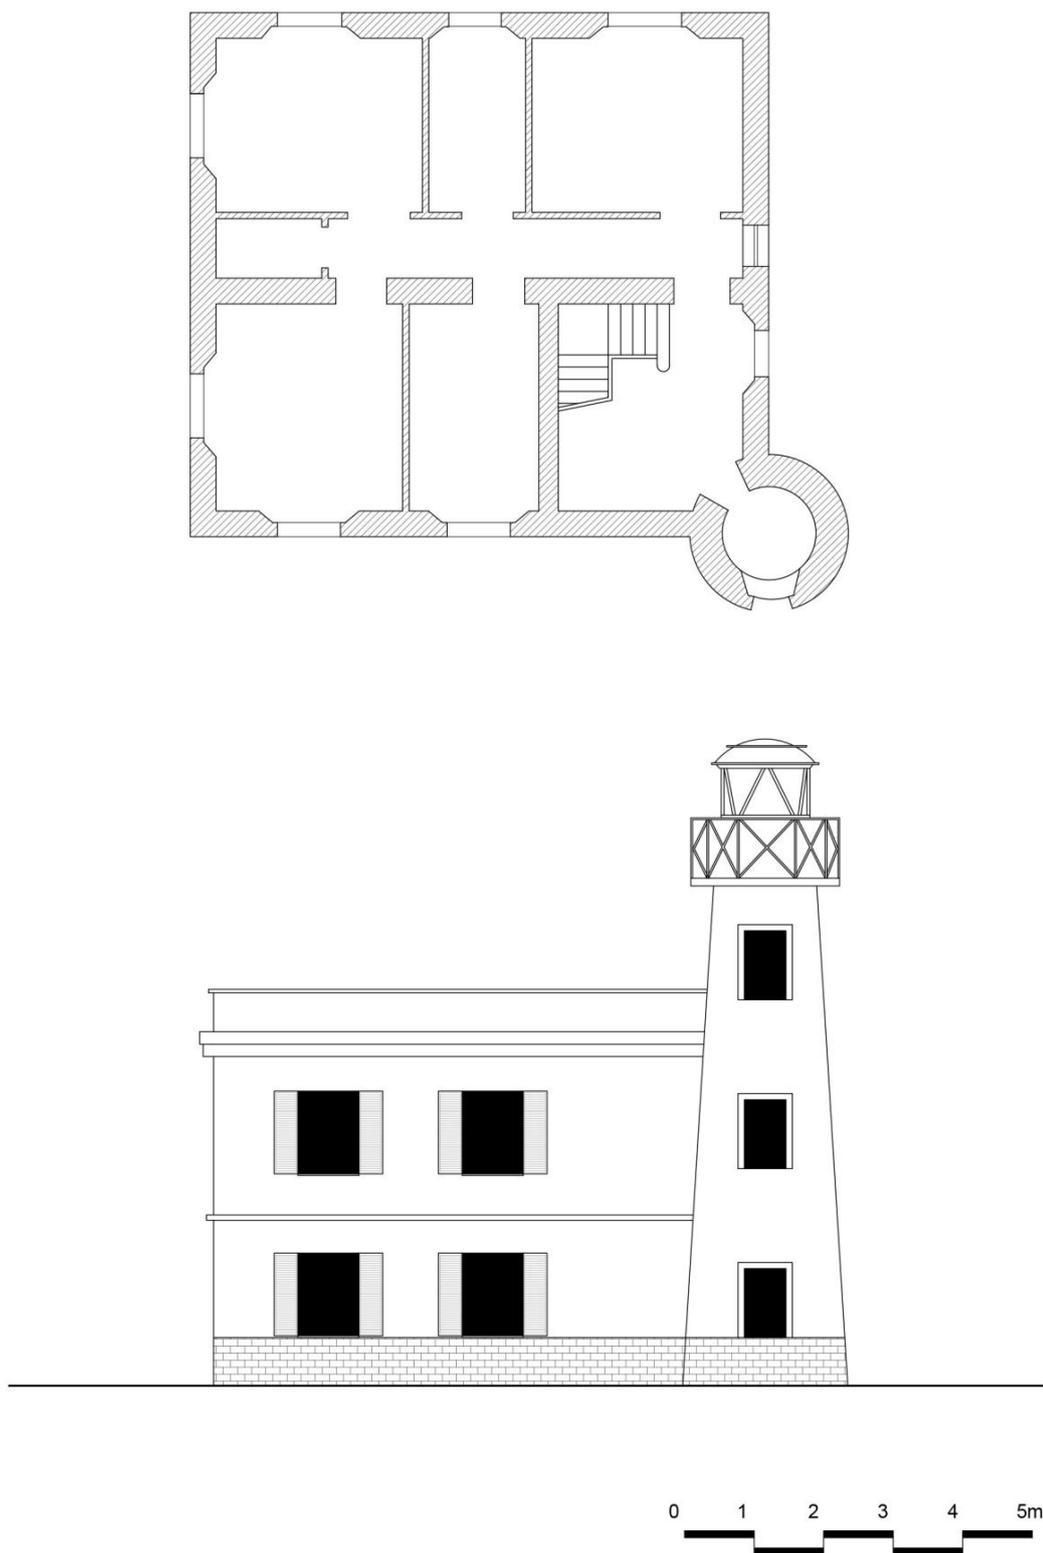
Esempio di faro a blocco con torre collocata in angolo, rielaborazione della pianta e prospetto del faro di Punta Imperatore.
